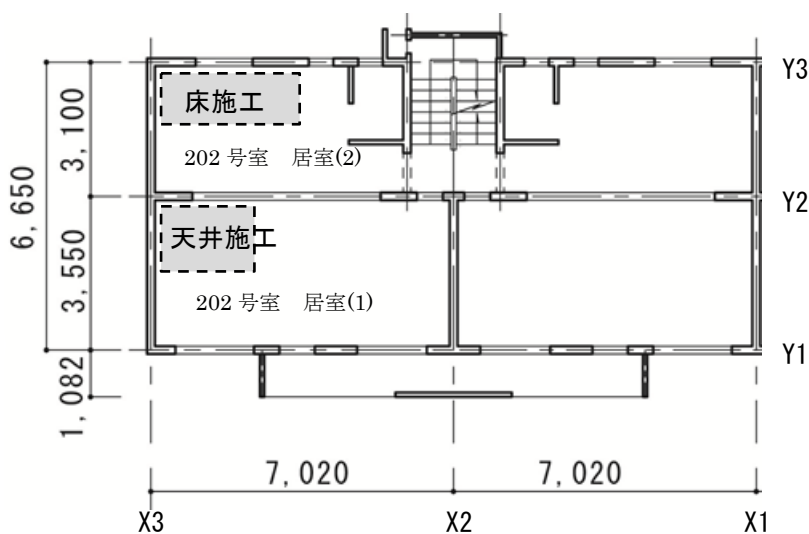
天井および床のアンカー施工位置 (平面図)
